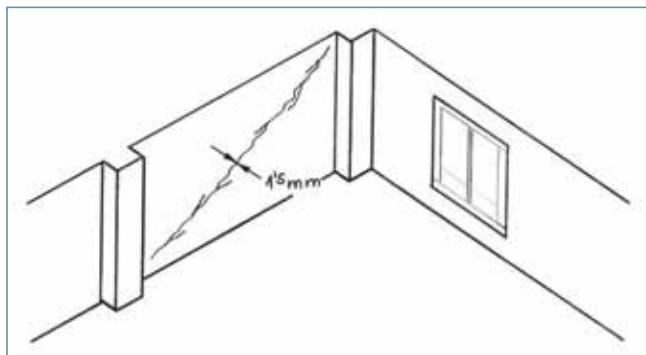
Vista según C (figura 3) a la altura de la 1^a planta.
